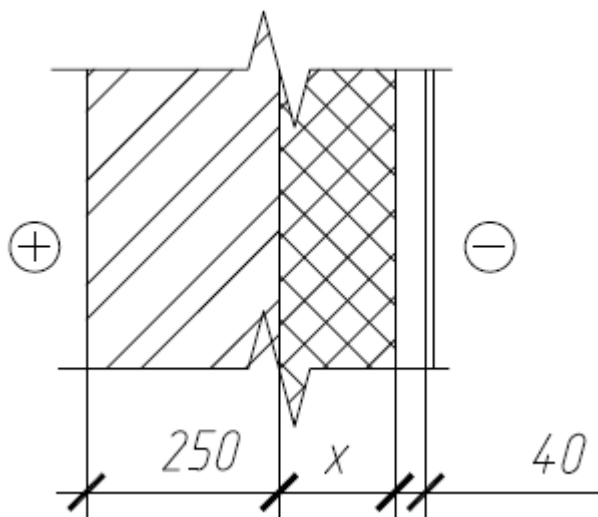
Конструкция наружной стены лестничной клетки
